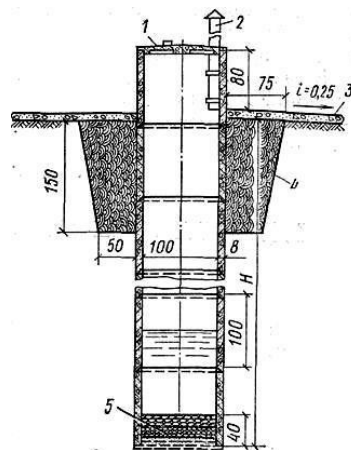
Шахтний колодязь із залізобетонних кілець:
